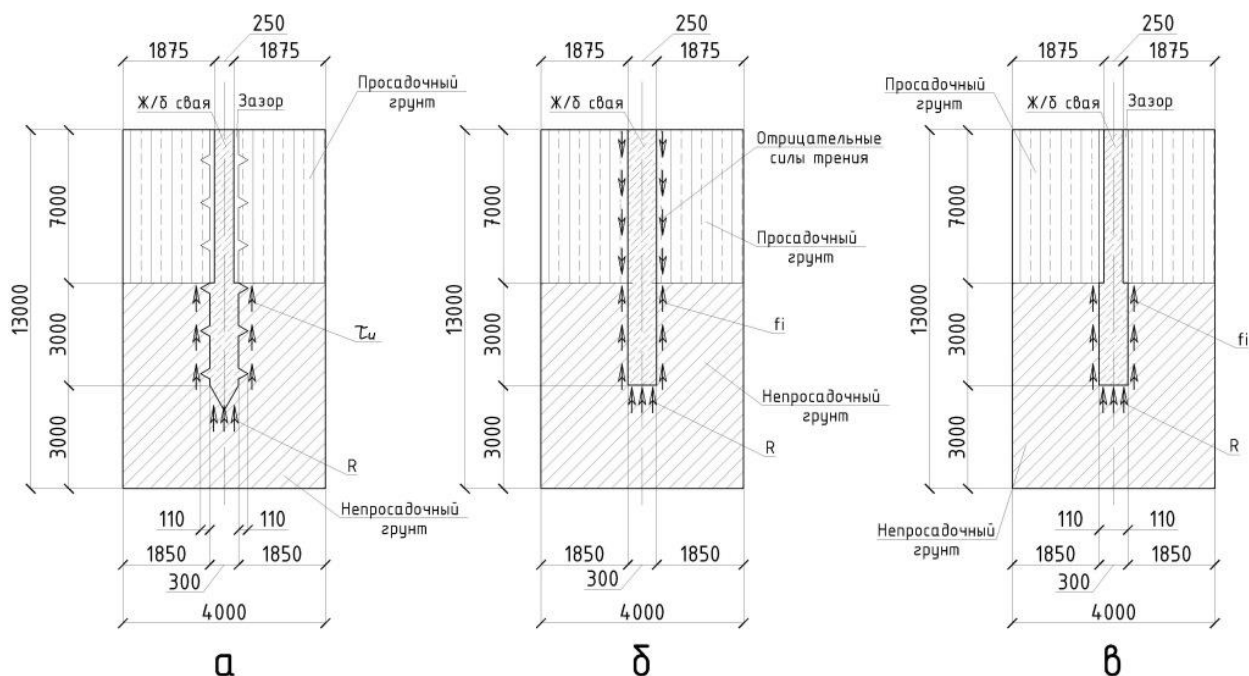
Расчетные схемы взаимодействия свай с грунтовым массивом, где: а- винтовая железобетонная свая, б – буронабивная железобетонная свая, в – буронабивная железобетонная свая с уширением;  $f_i$  – трение по боковой
